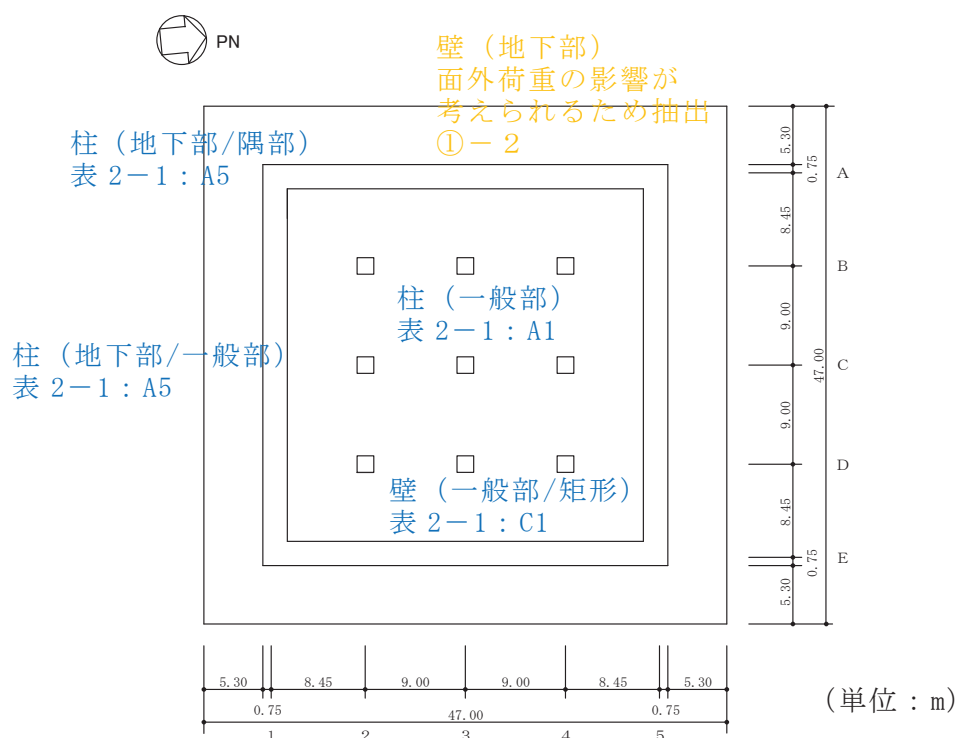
(1) 緊急時対策建屋の概略平面図 (O.P.\* 51.5m)
